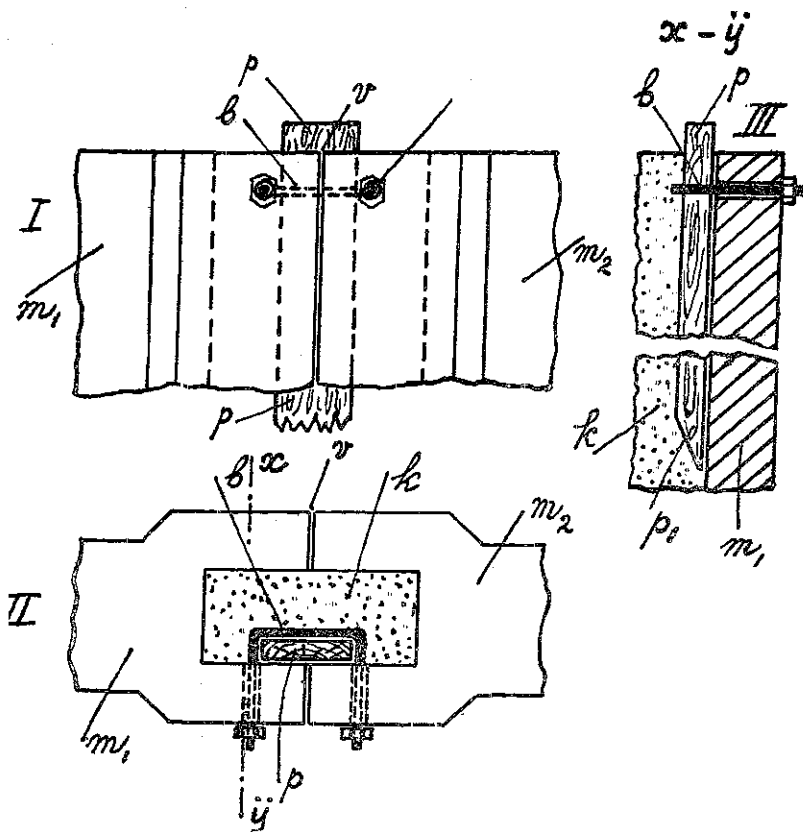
Aangifte van details van de ingeheide houten plank *p* in horizontale en verticale doorsneden en vooraanzicht
